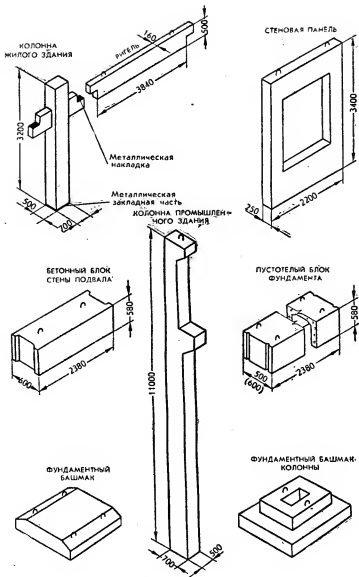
Сборные бетонные и железобетонные детали стен, каркаса и фундаментов.
